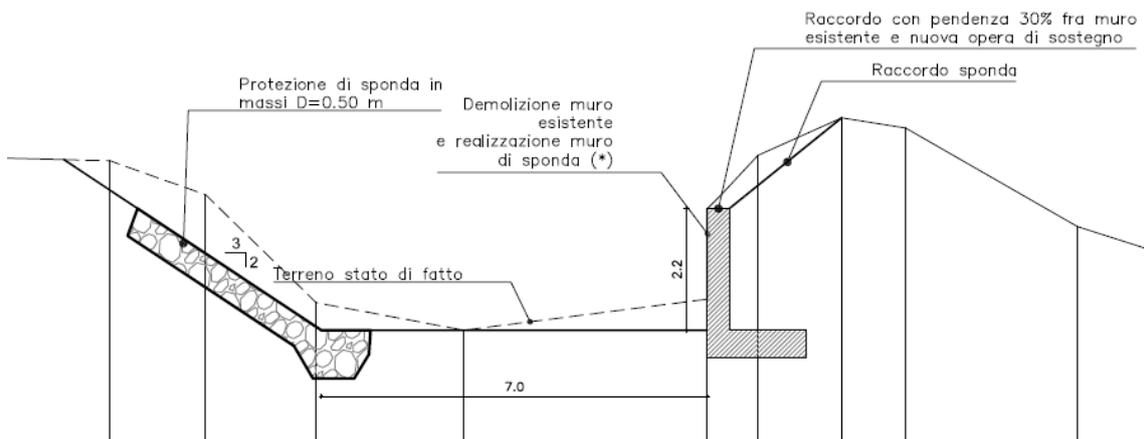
Sistemazione idraulica dell'alveo – primo tratto
